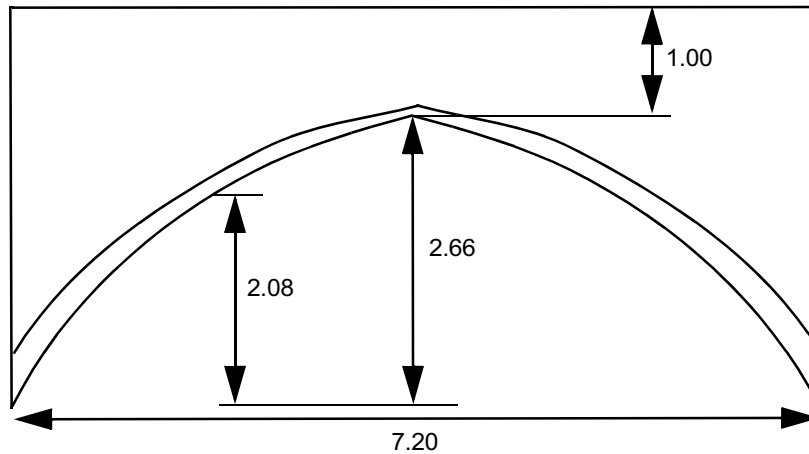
Geometria do arco da ponte Teston em Kent (dimensões em metro).
